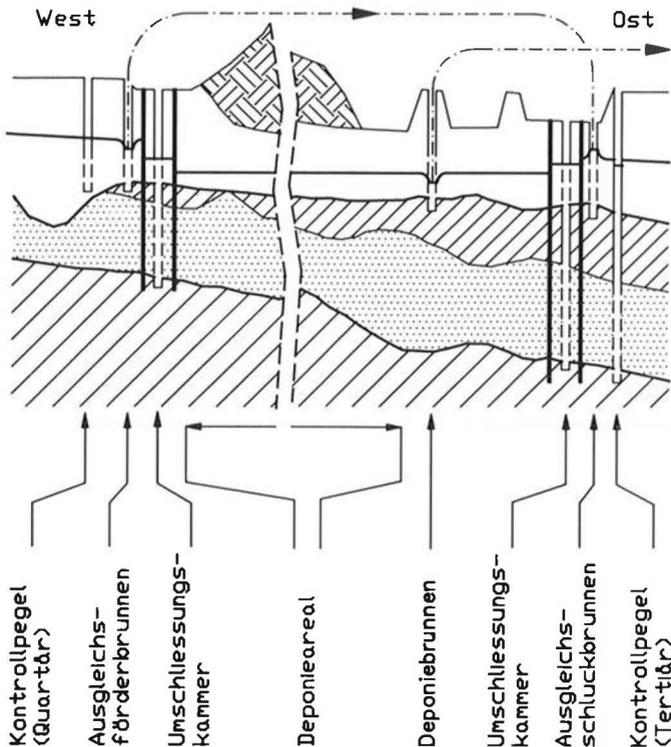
Querschnitt des umschlossenen Areals mit Dichtwänden (schematisch); Betriebsschema der Wasserhaltungen.
